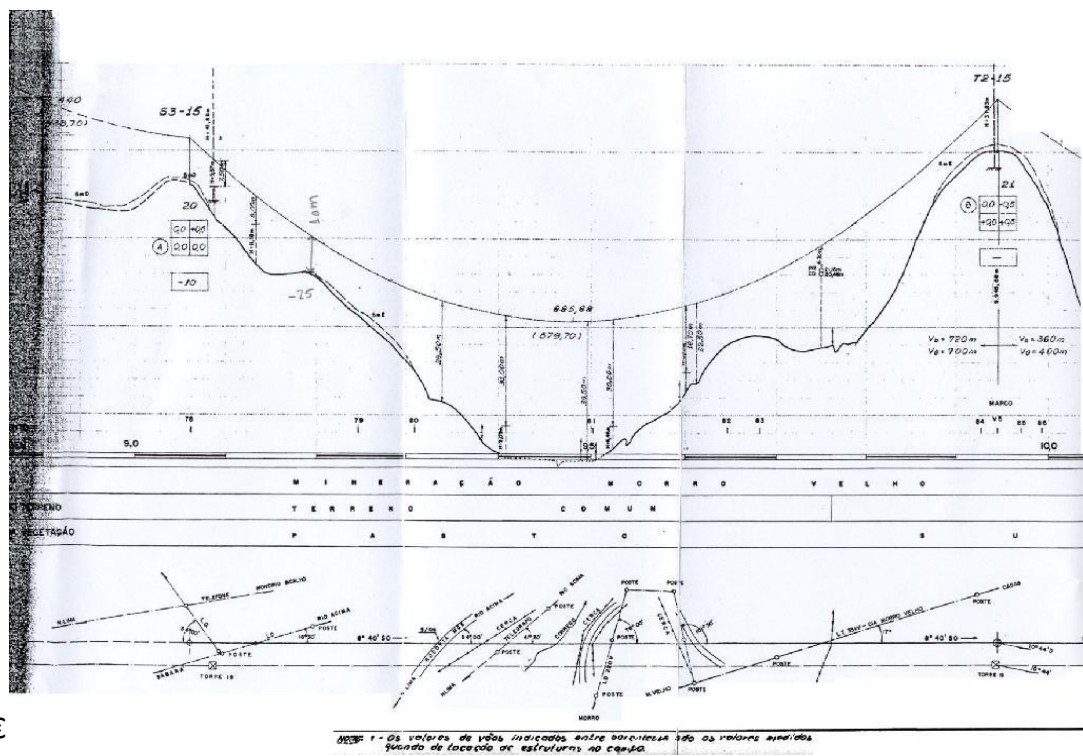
Perfil e Planta Original de um Vão da Linha Aérea 138 kV em estudo.
